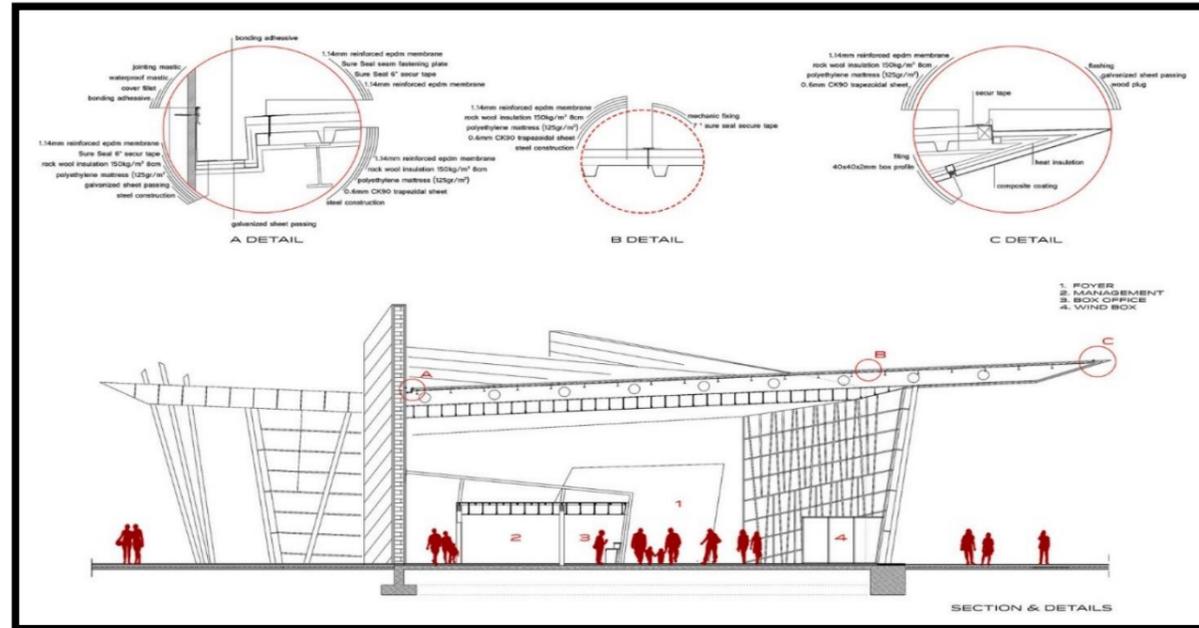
Sección y Detalles Estructurales de la Terminal de Kayseri. Fuente: Plataforma Arquitectura.
